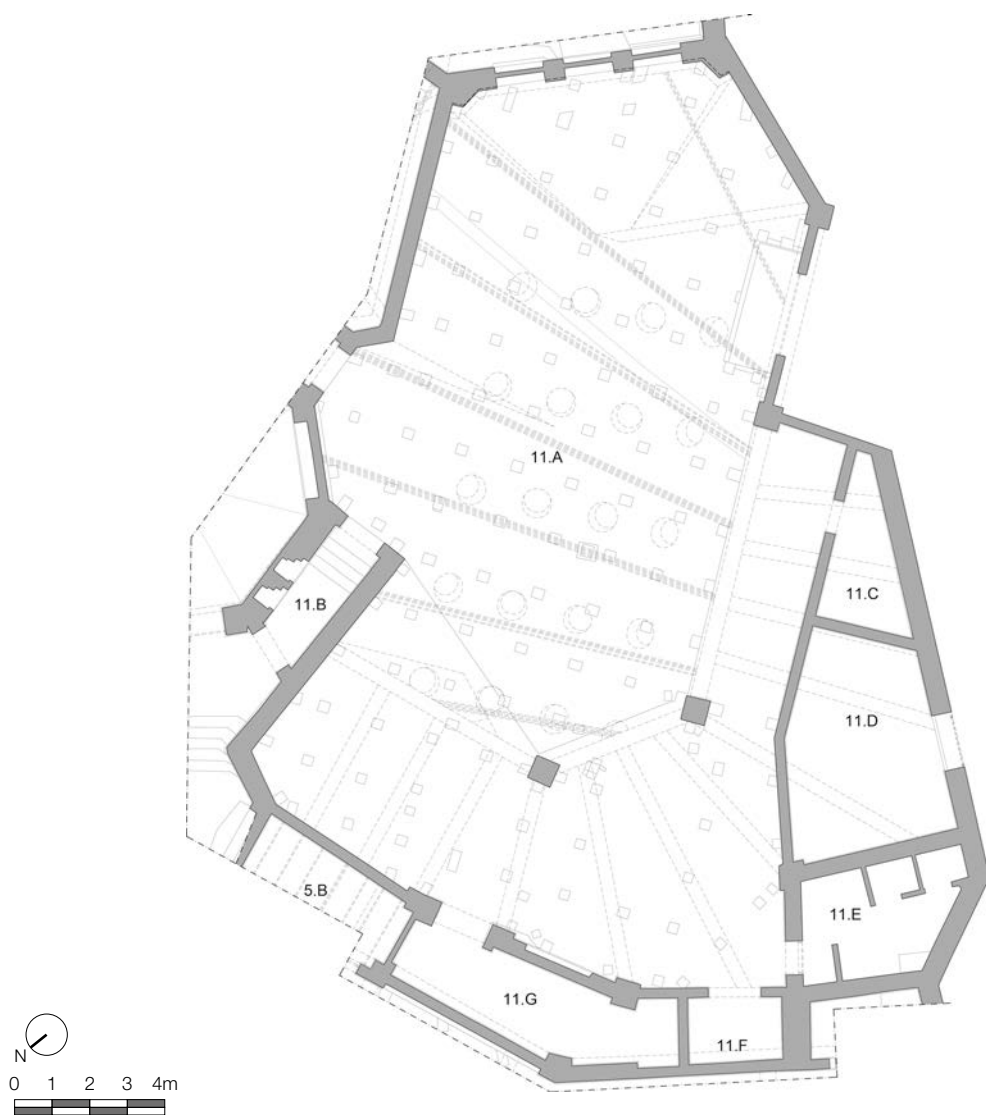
| Planta del bloque 11 (escala original de representación 1:50). | Planta del blocco 11 (scala originaria di rappresentazione 1:50).
